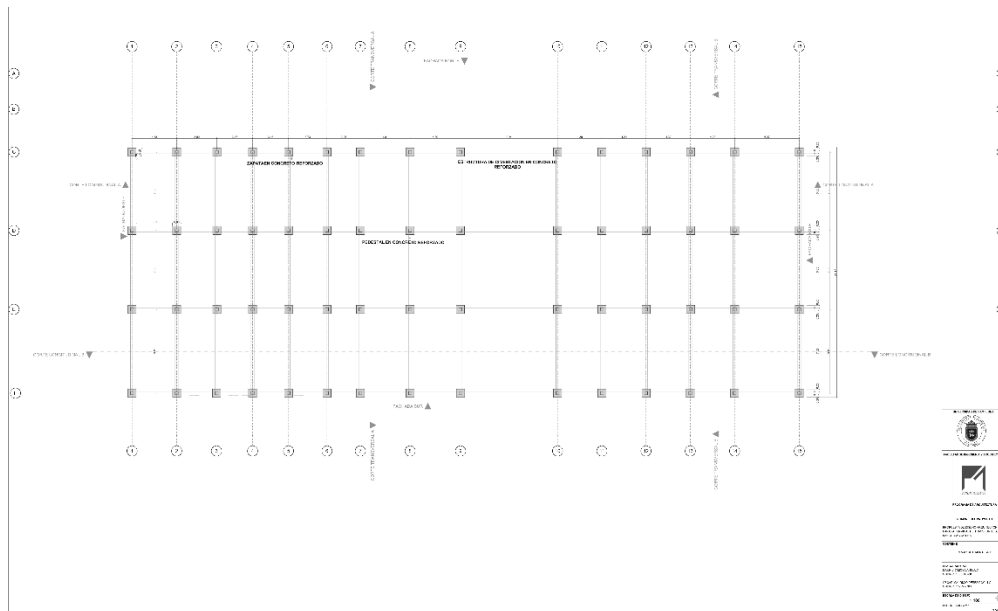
Plano de cimentación, Fuente: elaboración propia.
